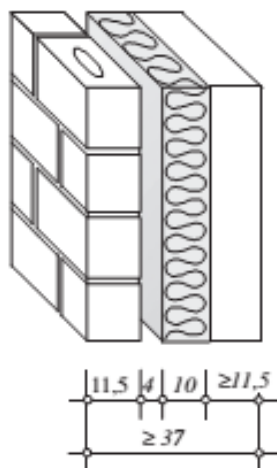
Esquema de construção de uma parede em TFV com isolamento (parede dupla) (cm) [26]
